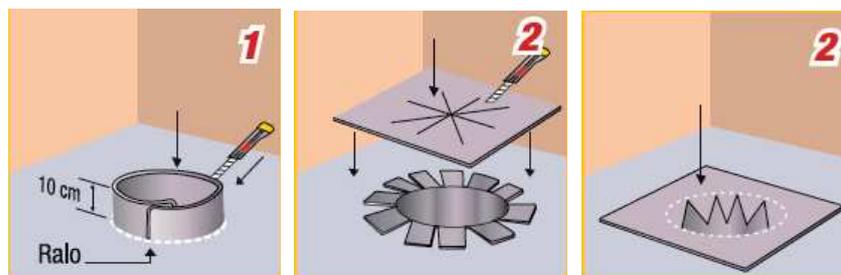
Detalhe da execução do reforço da impermeabilização dos ralos
